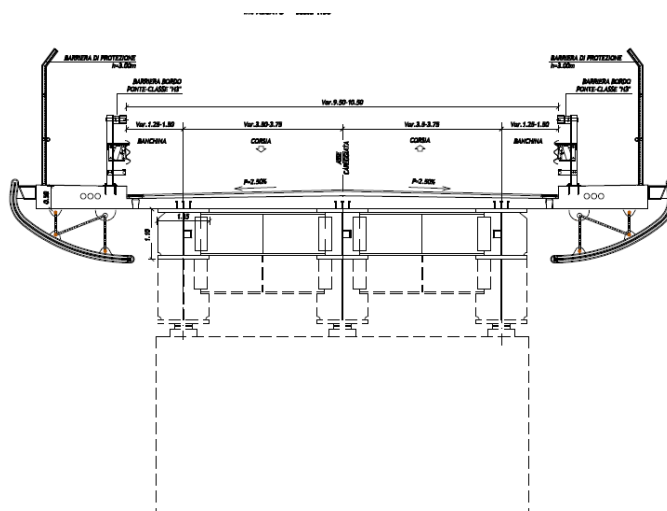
SEZIONE TIPO IMPALCATO CAVALCAVIA DI STRADA PROVINCIALE
